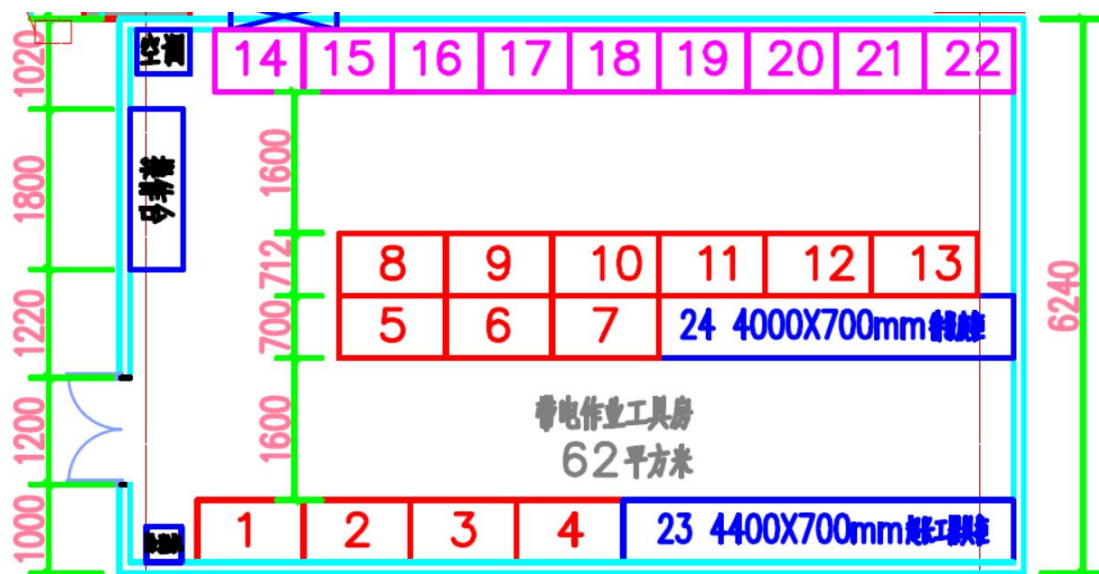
4F 集装箱式带电作业安全工器具房平面布置图
